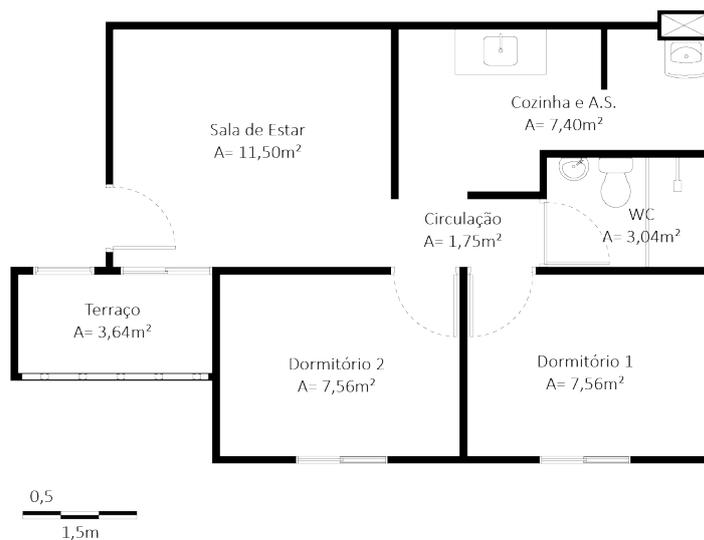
Planta do apartamento tipo do edifício multifamiliar.
